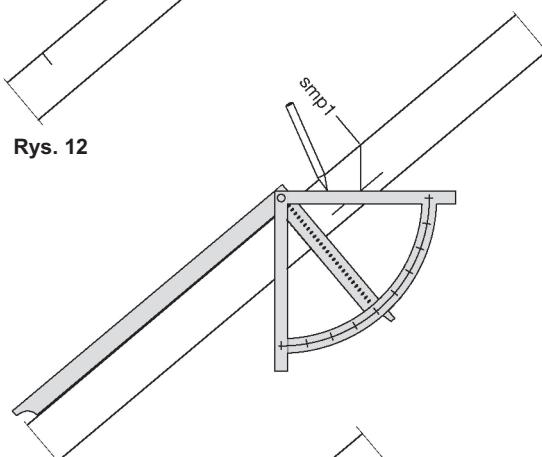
do 14 przedstawia przykładowy sposób postępowania przy wyznaczaniu zacięcia w krokwi pod płytew, dla której trzeba wyznaczyć linię pionową *smp1*.
